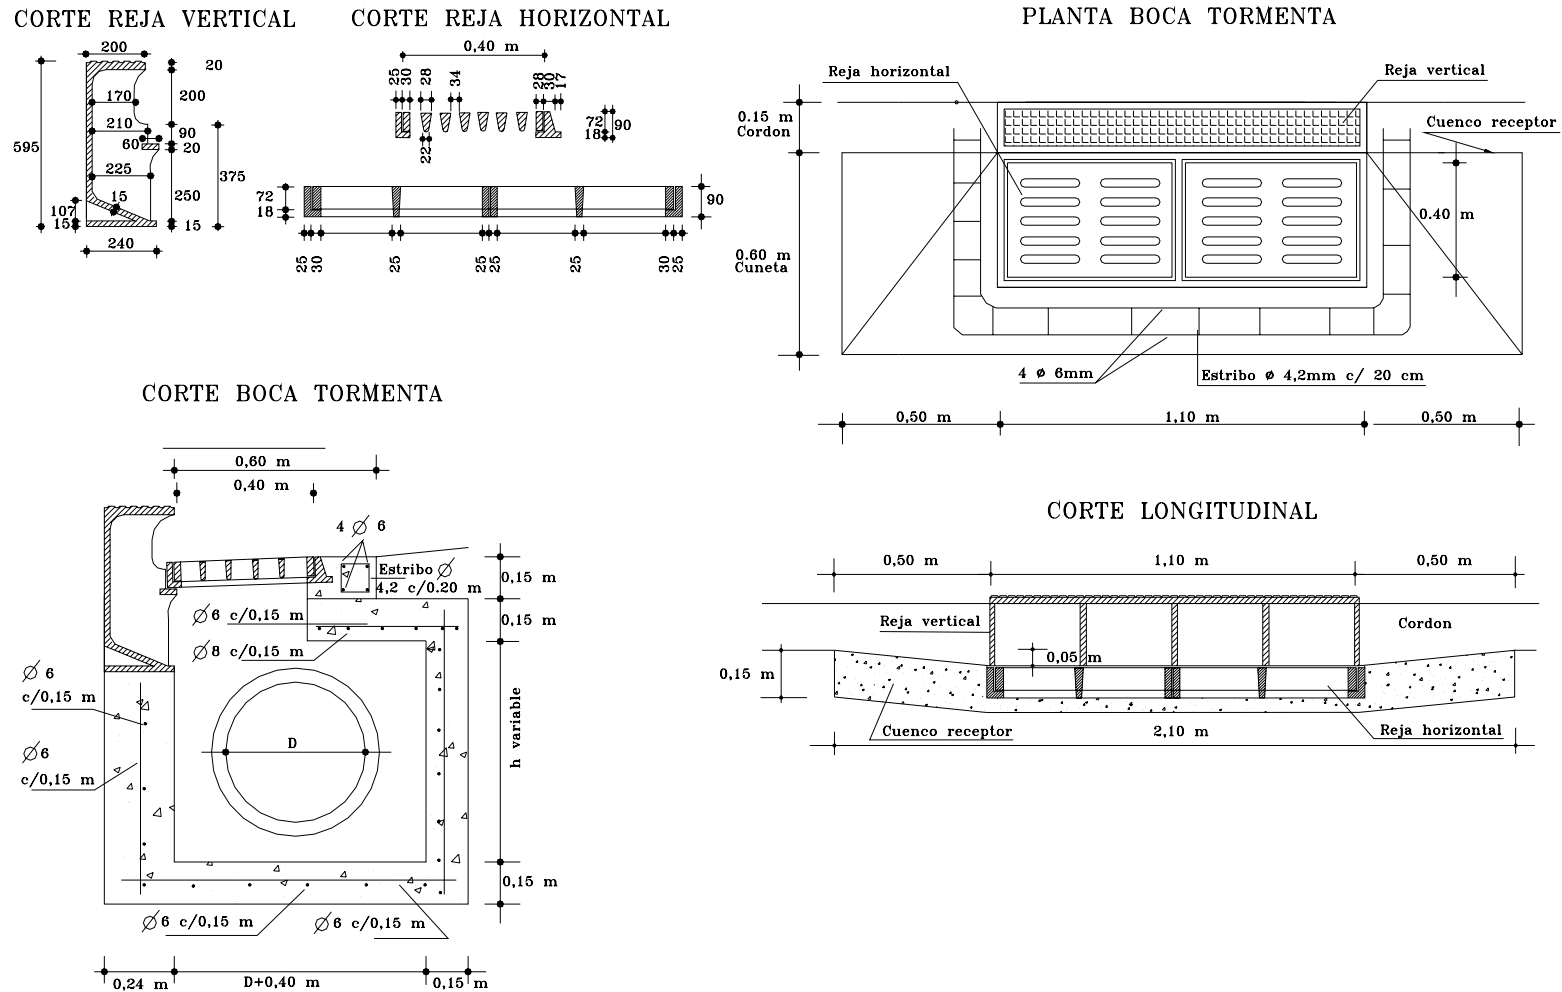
Cámara de entrada bajo pavimento (fuente: Municipalidad de Santa Fe).
